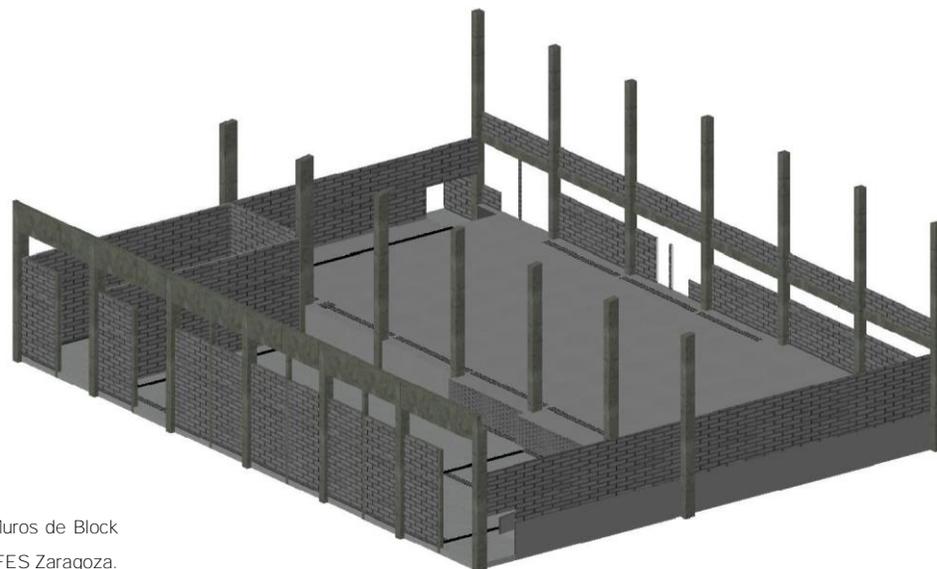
Modelo 3D- Muros de Block vidriado en Planta Piloto FES Zaragoza.
